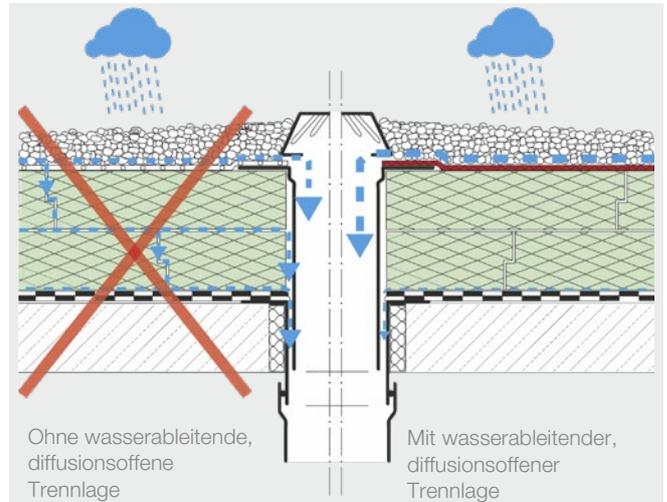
Ausführung zweilagig bekiestes Umkehrdach.
